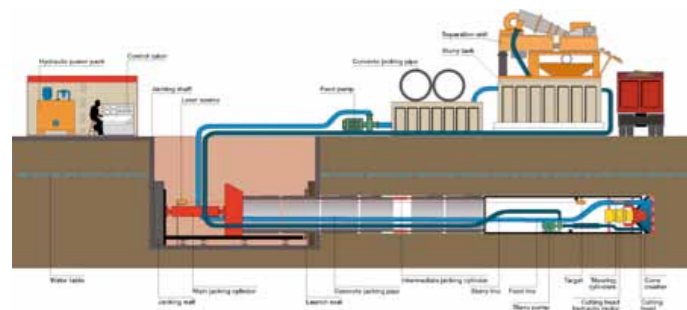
Tipico allestimento di cantiere di microtunnelling
